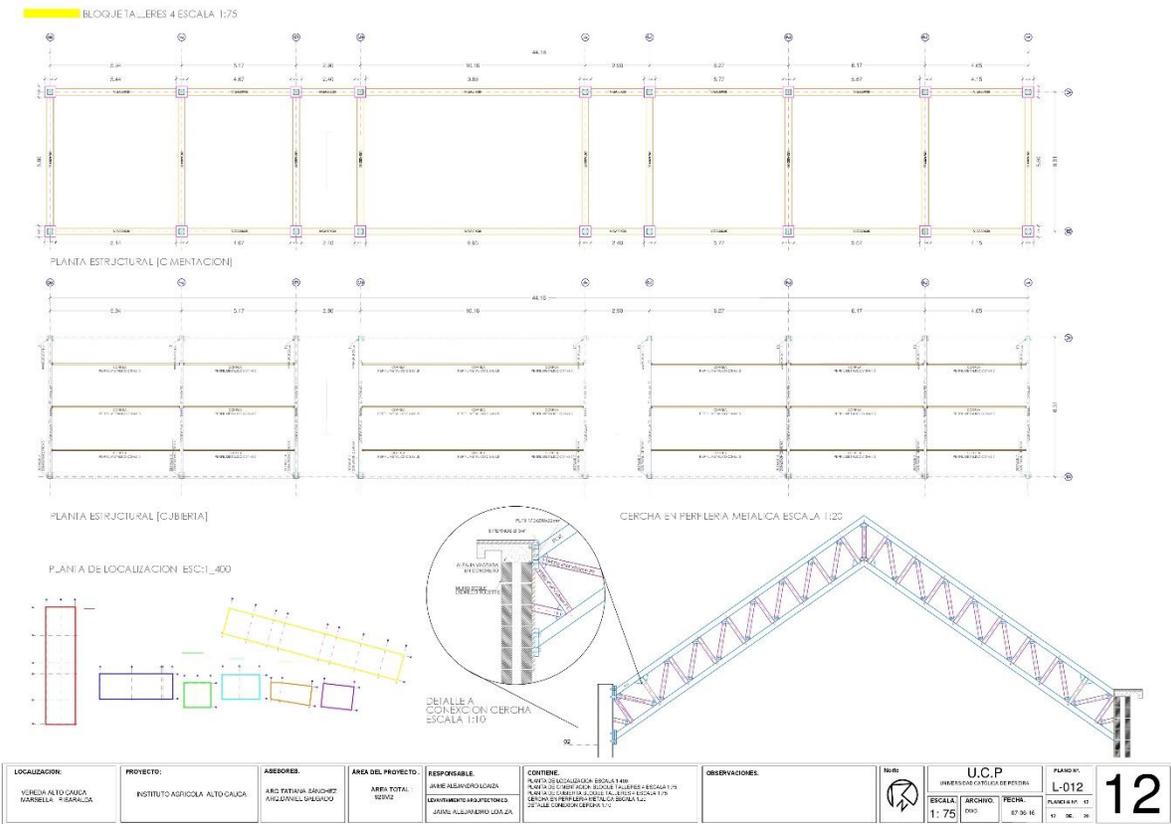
PLANOS: CIMENTACION, ESTRUCTURAL, ENTREPISO DE BLOQUE TALLERES 4, DETALLES.
